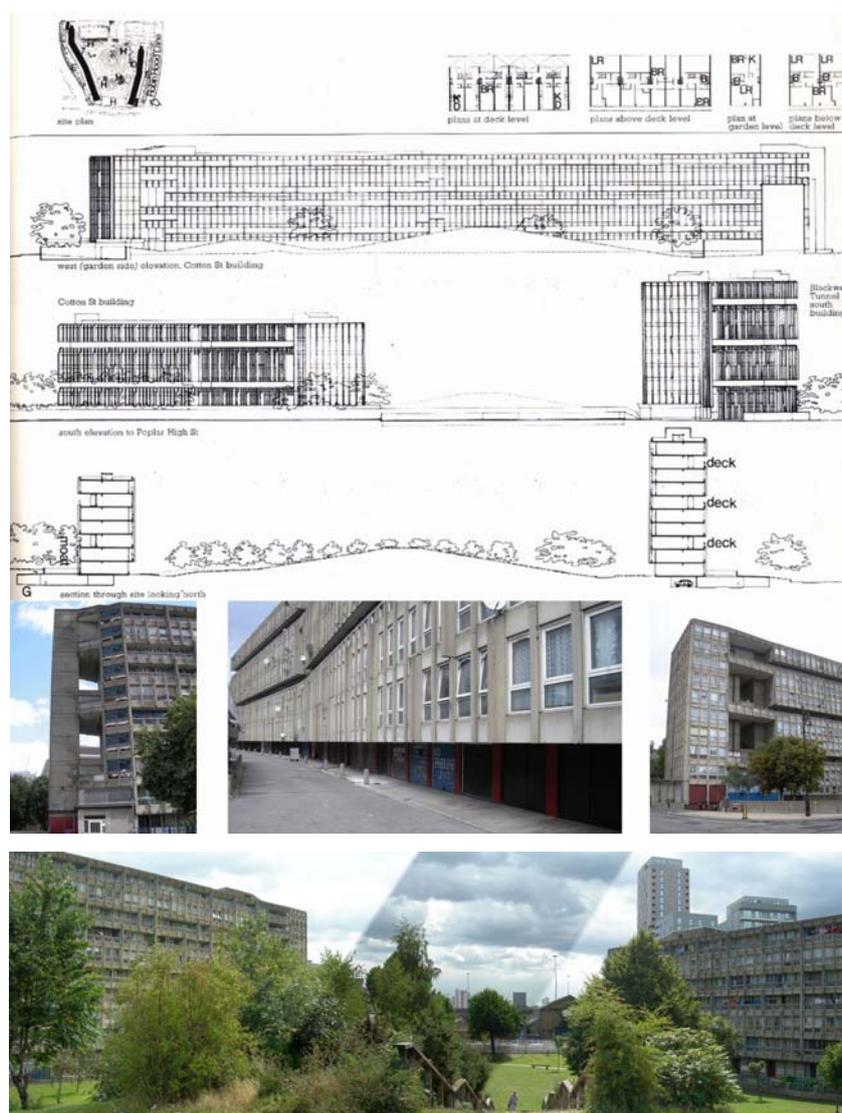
Robin Hood Garden*. Planimetria generale, piante tipo, prospetti e sezione, tratti dalla rivista inglese *Architectural Review*, n.883 del settembre 1970.
